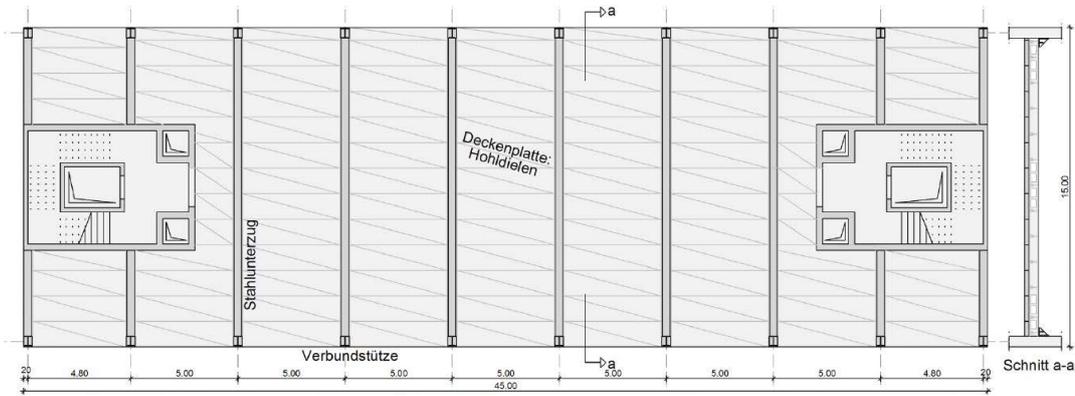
Deckenuntersicht Decke über EG (Unterzugsdecke: stählerne Unterzüge und Hohlrielen)
